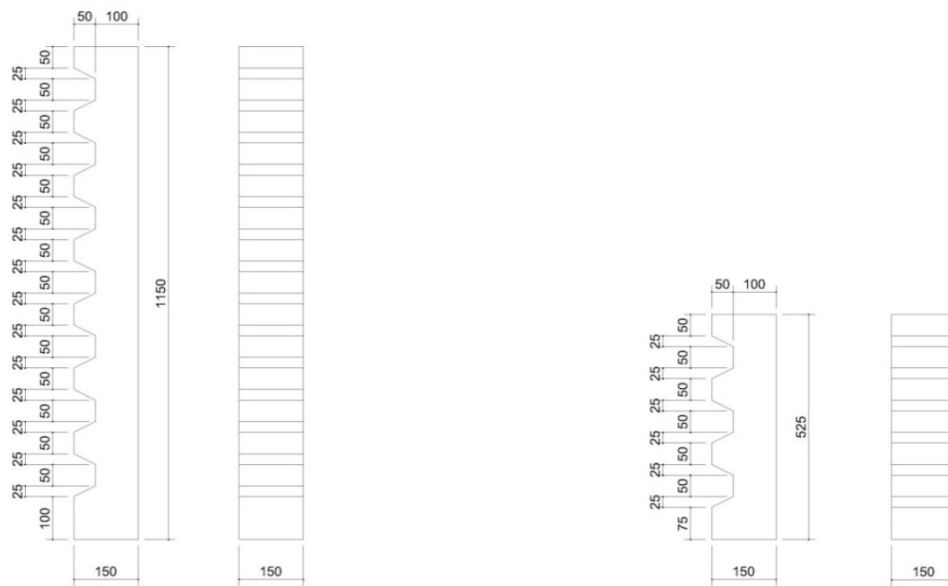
Dimensiones (en mm) de las piezas de madera maciza para la fabricación de las llaves en la junta de siete llaves (izquierda) y en la junta de tres llaves (derecha)
